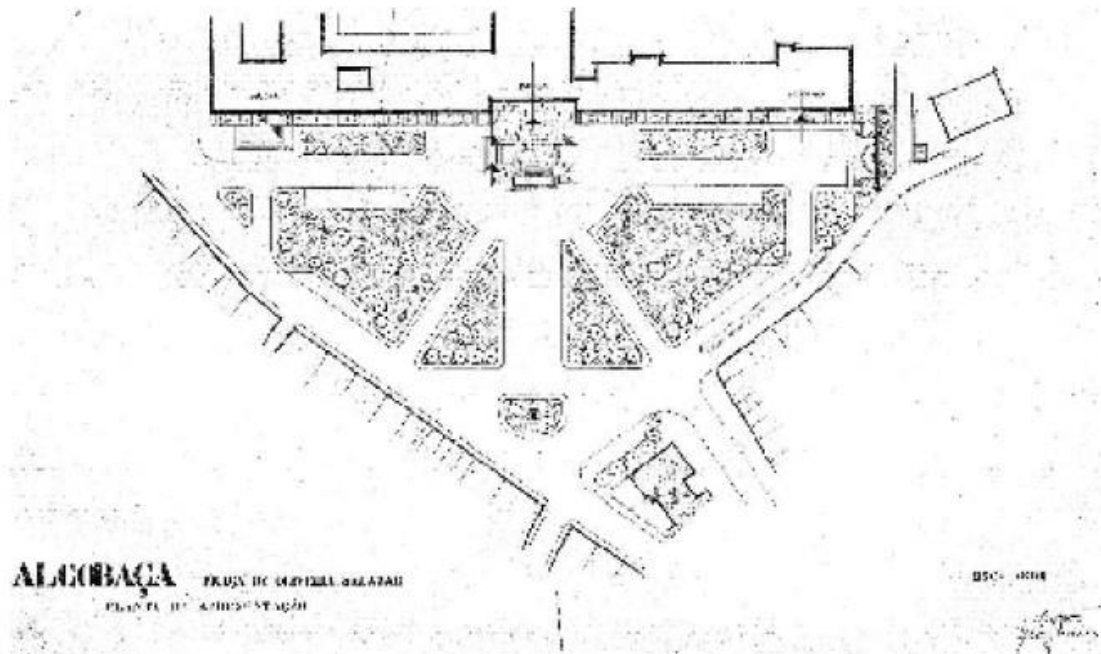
Mosteiro de Alcobaça numa planta de arranjos exteriores. Projeto do arquiteto João Vaz Martins
